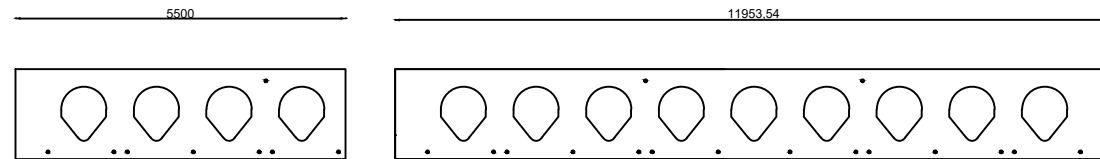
DETAIL PEMASANGAN SEGMENT PLAT P1 LT. 20-24
